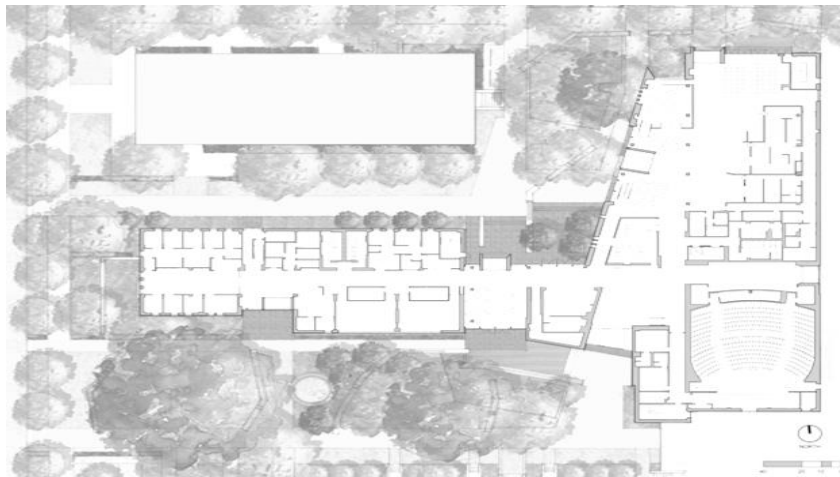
Planta Baja (Student Activity Center) | Fuente ArchDaily
